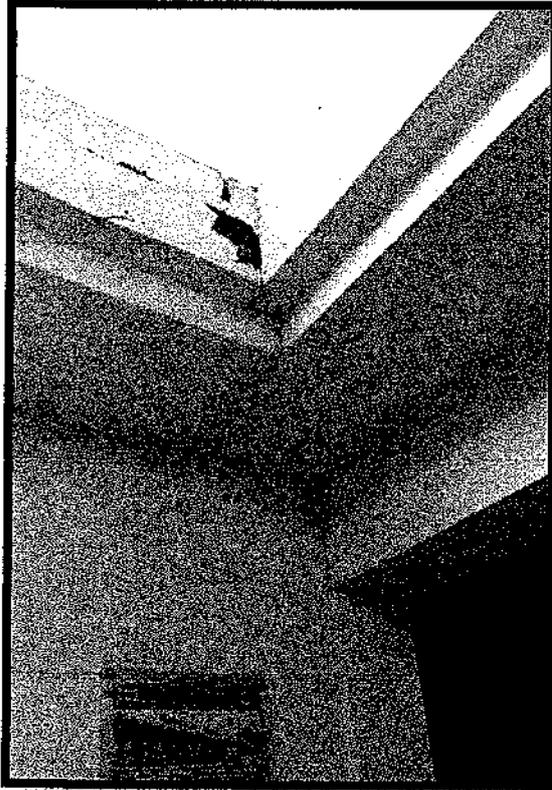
DETERIORO DE LA LOSA EN CONSULTA EXTERNA
